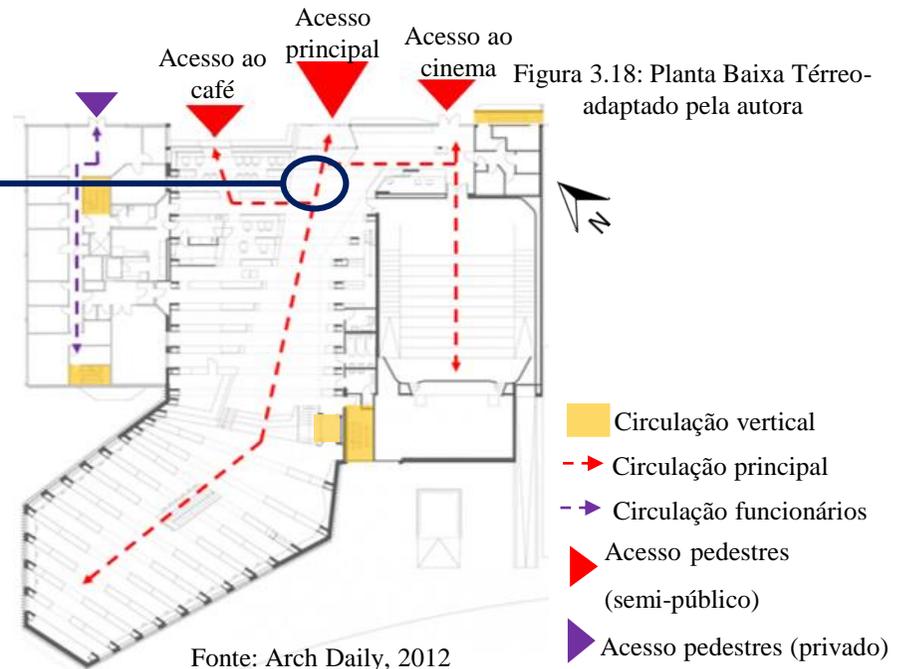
Planta Baixa Térreo- adaptado pela autora
